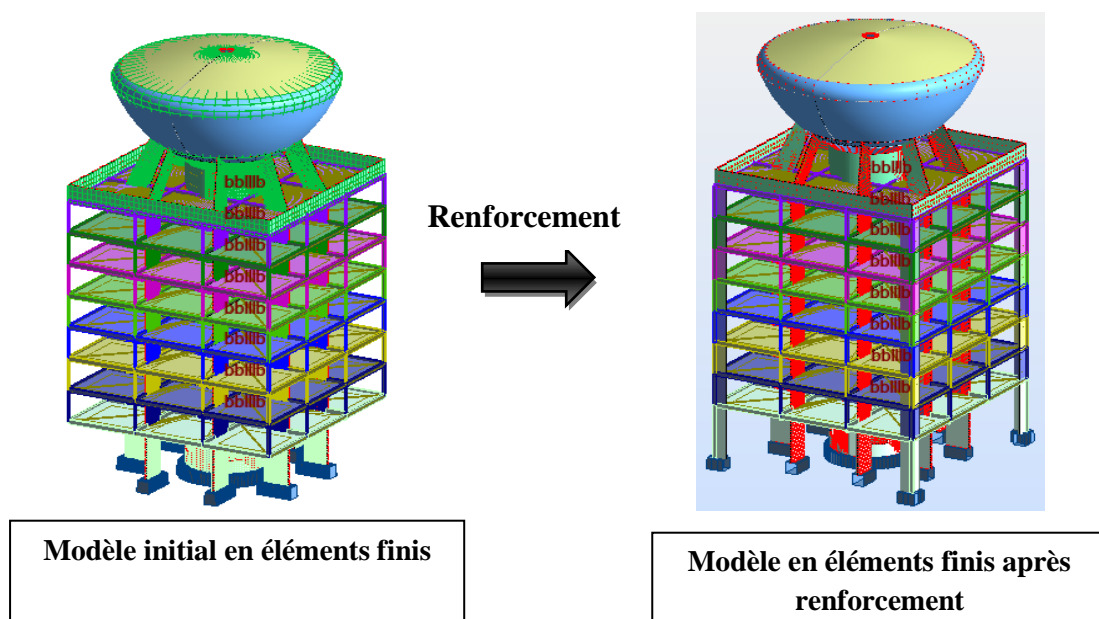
Renforcement par ajout d'éléments structuraux (voiles)
